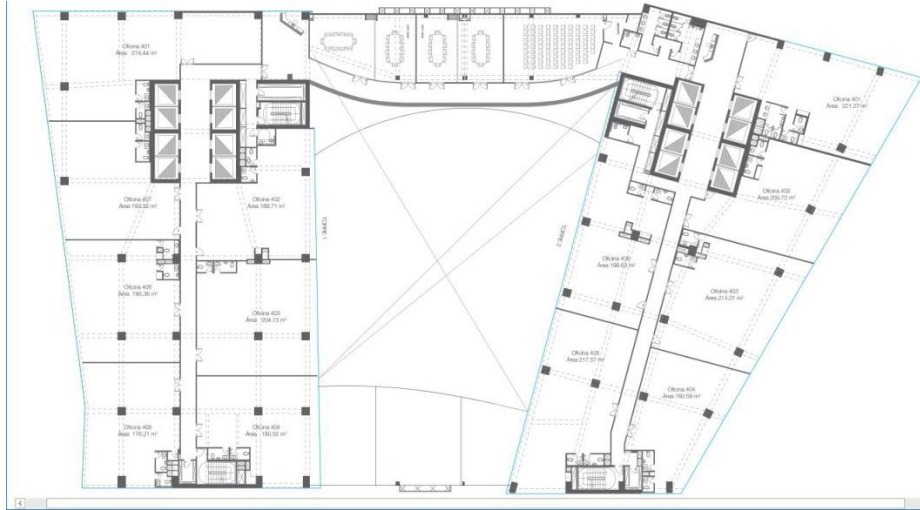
Planta típica Torres 1 y 2, Planta 4° al 7° piso del Centro empresarial “Panorama”.
